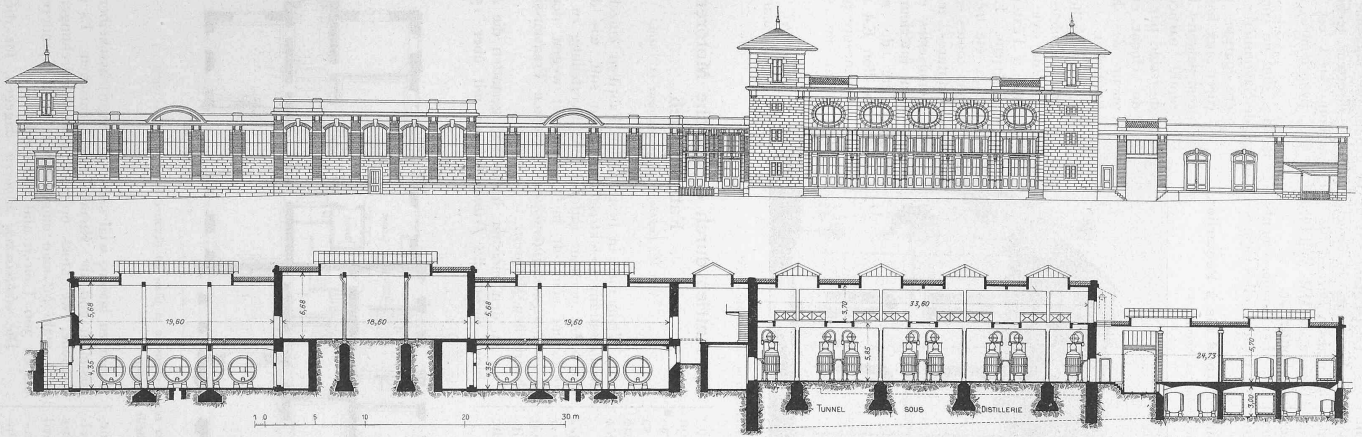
et 7. Façade sud et coupe longitudinale. — Echelle 1 : 500.
